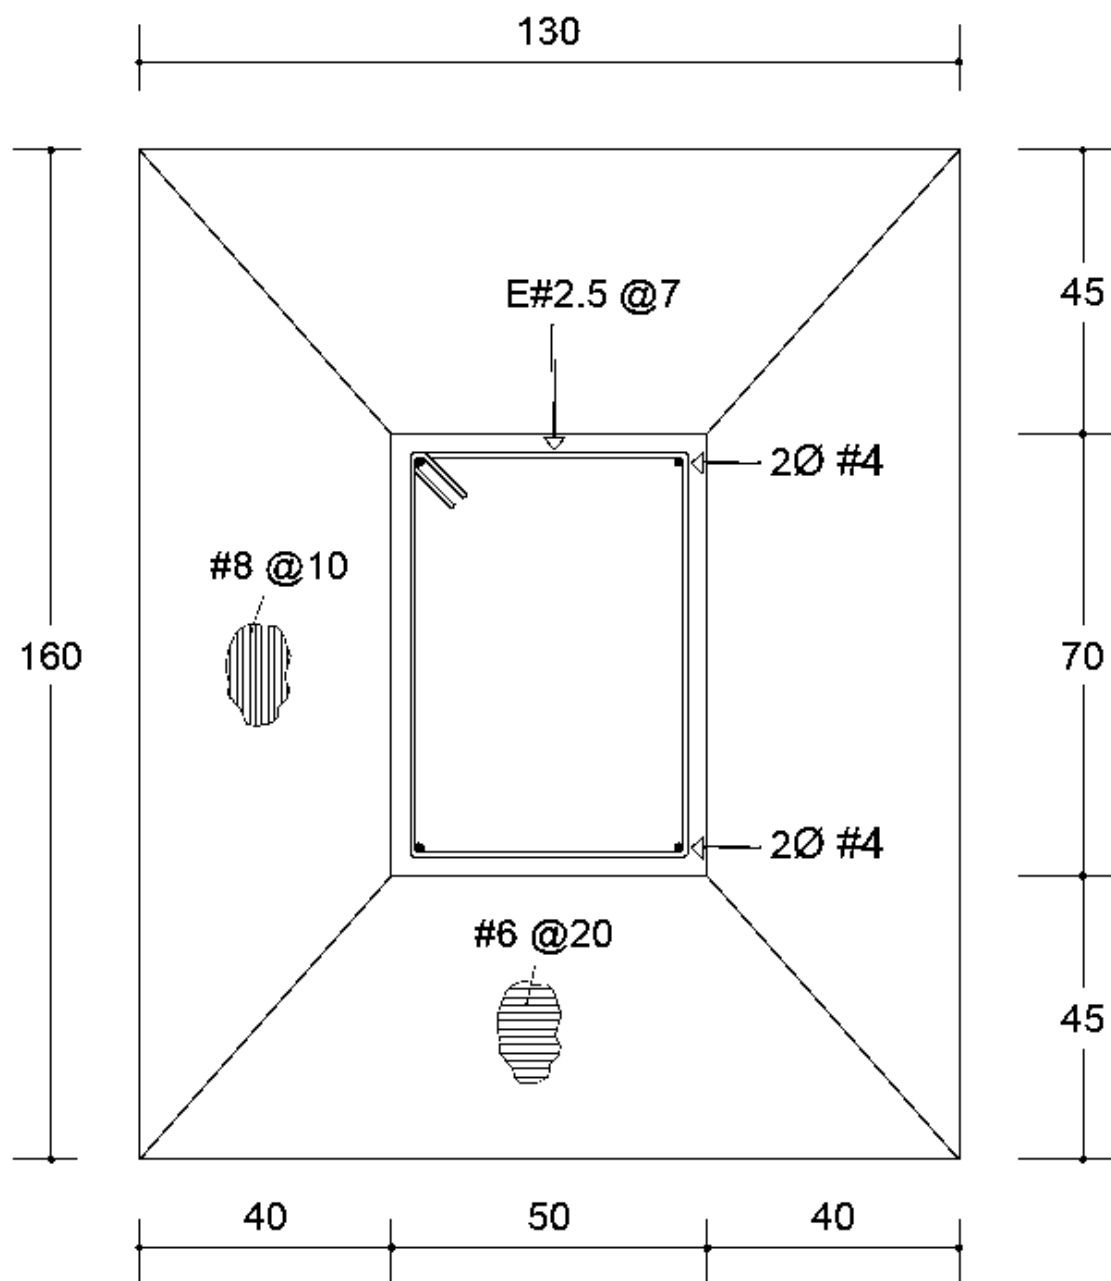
(e) Vista en planta de la zapata, (cm)
